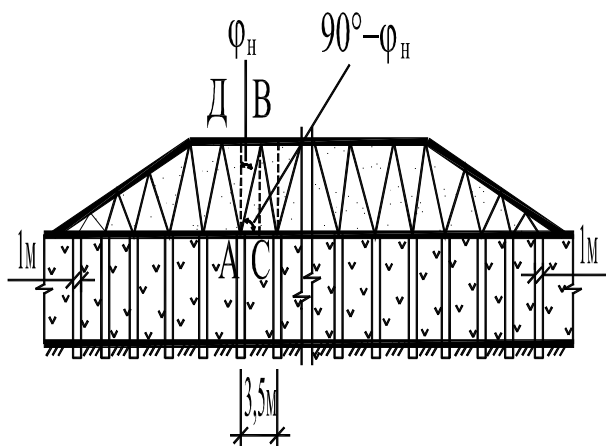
Поперечный разрез насыпи, укрепленной сваями
